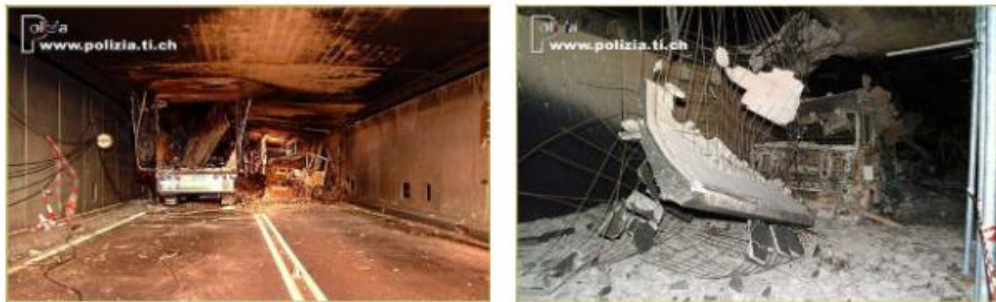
Photos du tunnel Saint Gotthard suite à l'incendie de 2001. A droite, effondrement du faux plafond en béton du tunnel [Mindeguia, 2009]
